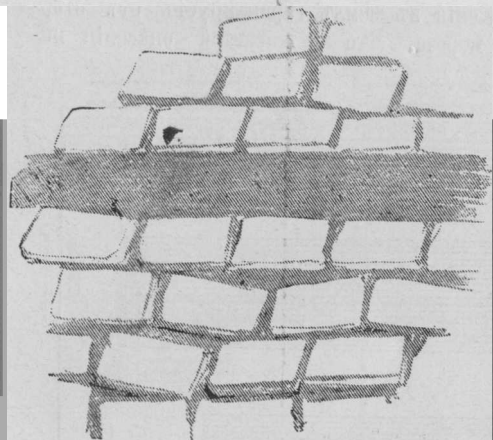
Кирпичная кладка пола Саксенгаузенского плодохранилища.
